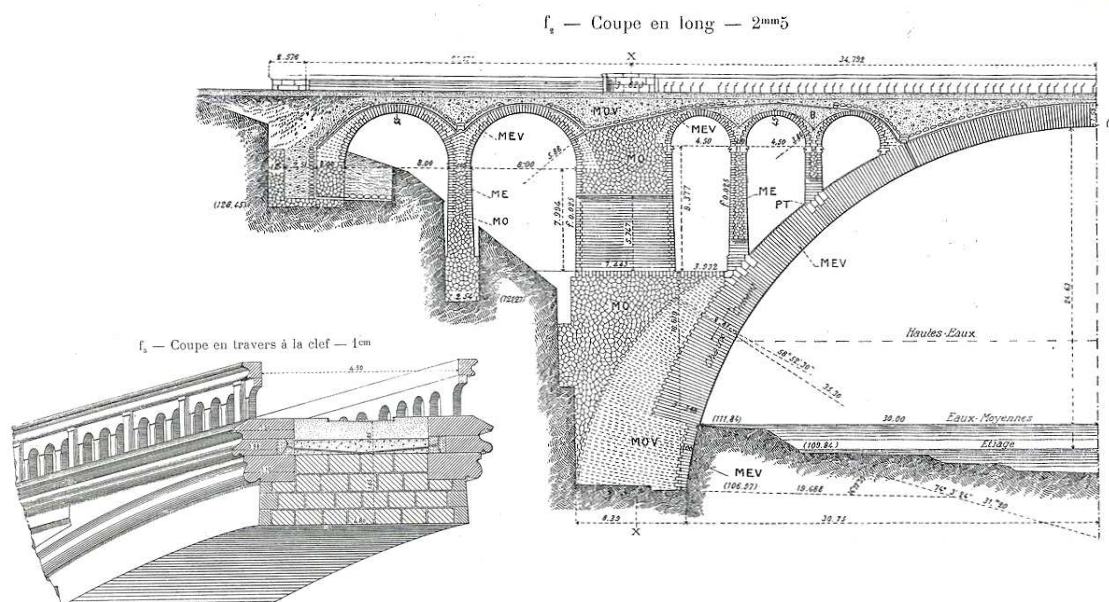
Pont de Lavaur, sur l'Agout, grande arche en pierres (Séjourné).
